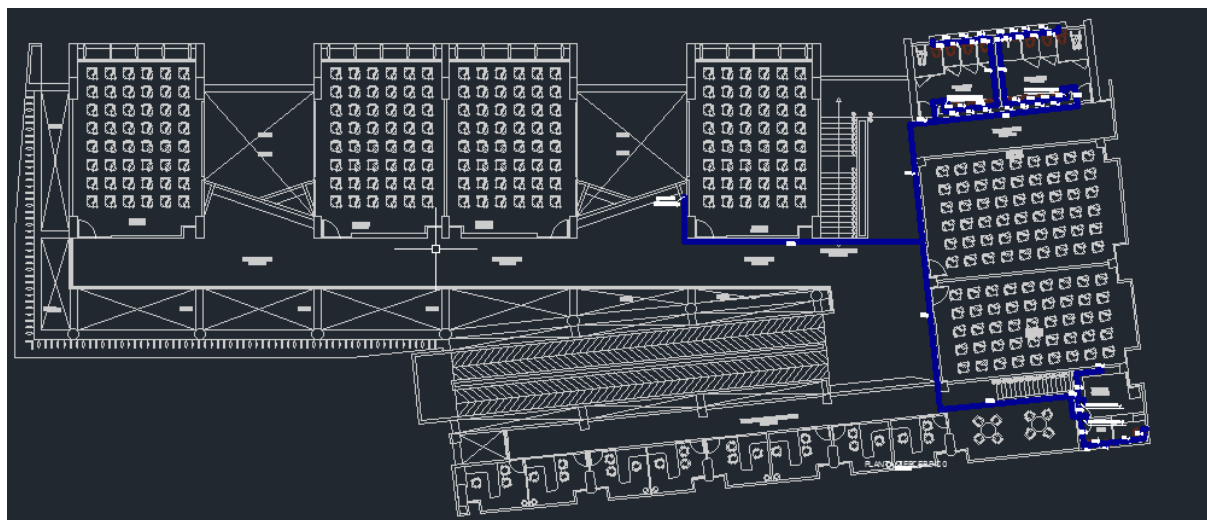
AutoCAD 2D Planta N°3 del edificio aulas oriente.
